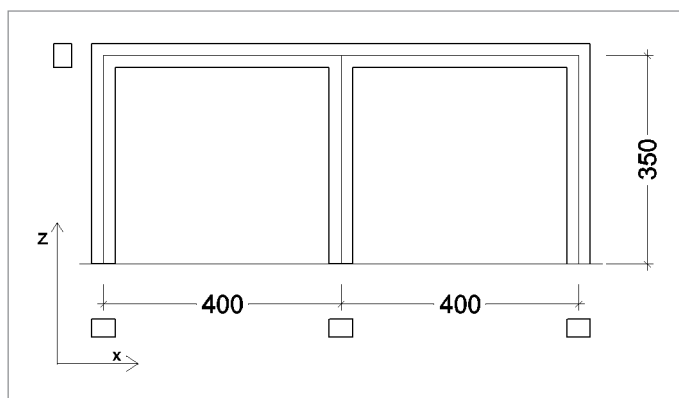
Schema del telaio piano in calcestruzzo armato
